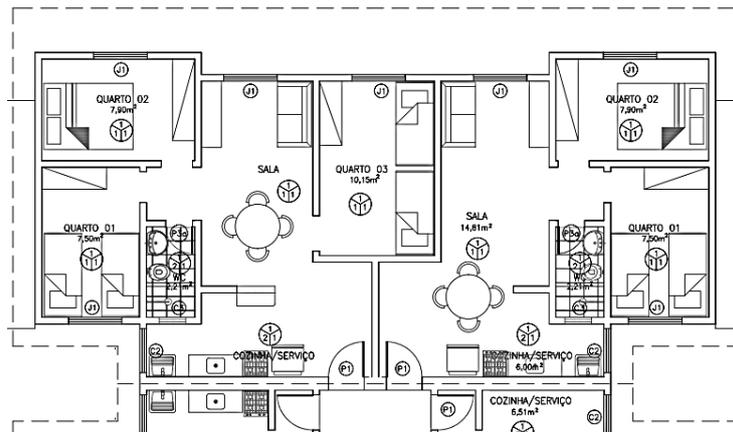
Planta Baixa do bloco tipo D1. Térreo. T2a e T3a.
